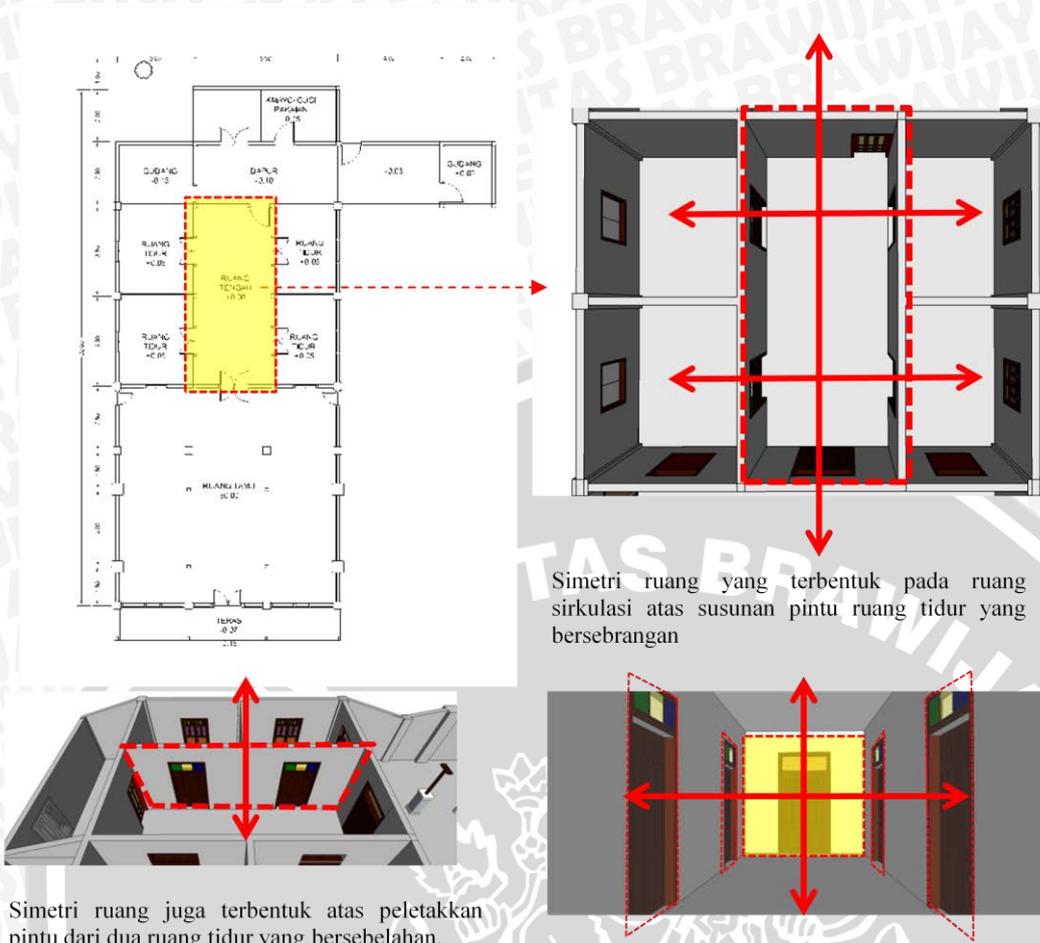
Simetri parsial ruang tamu rumah Bapak Fatkur
